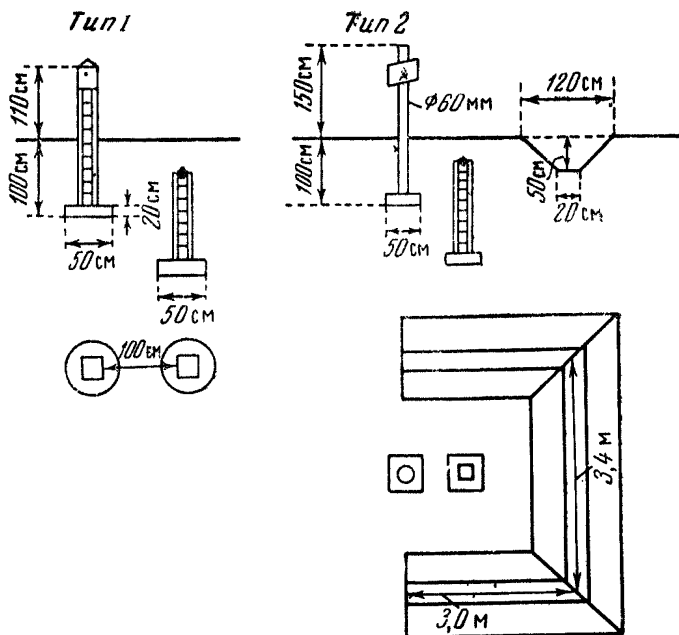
Наружное оформление грунтового репера в районах сезонного промерзания грунта
